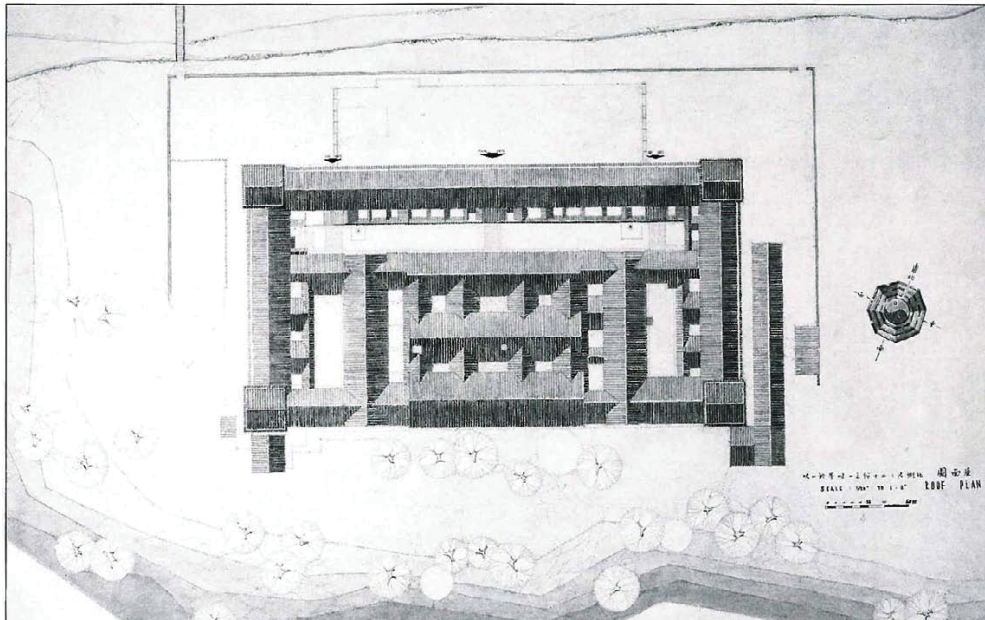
Links oben: Lageplan von Shan Ha Wai
